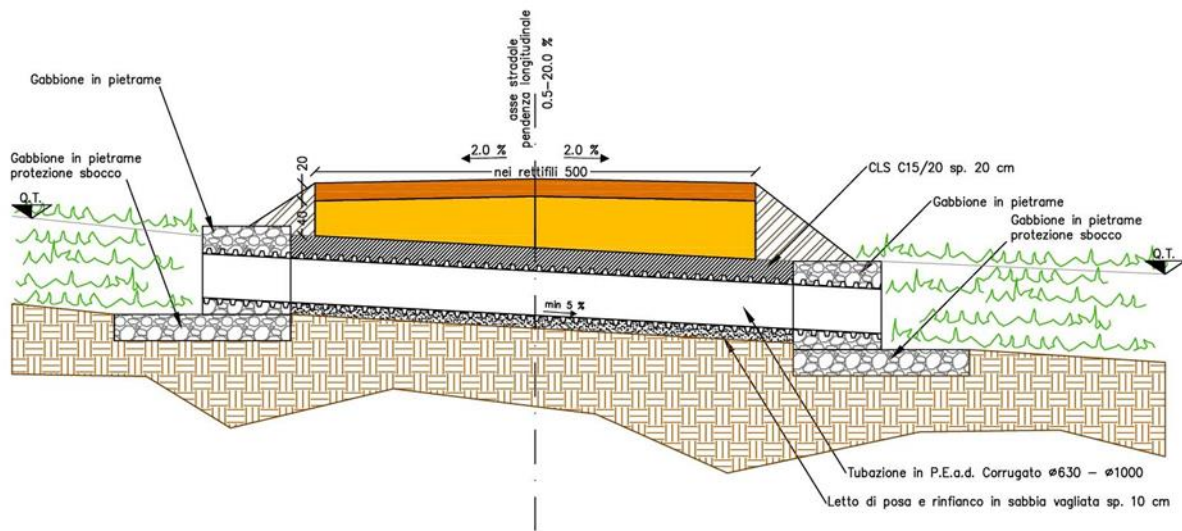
particolare tipo tombini in progetto con opere di protezione
